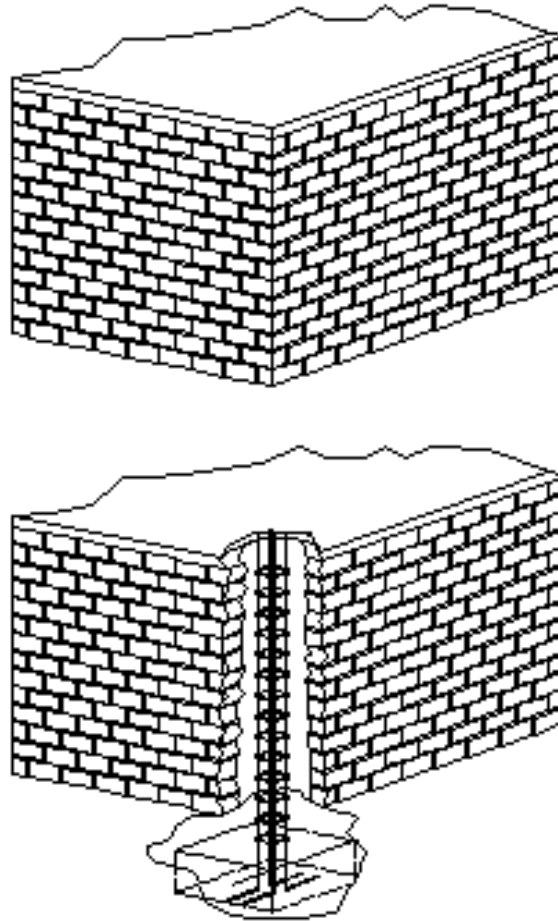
Detalle de inclusión de columnas de reforzamiento en muro sin confinamiento existente.
